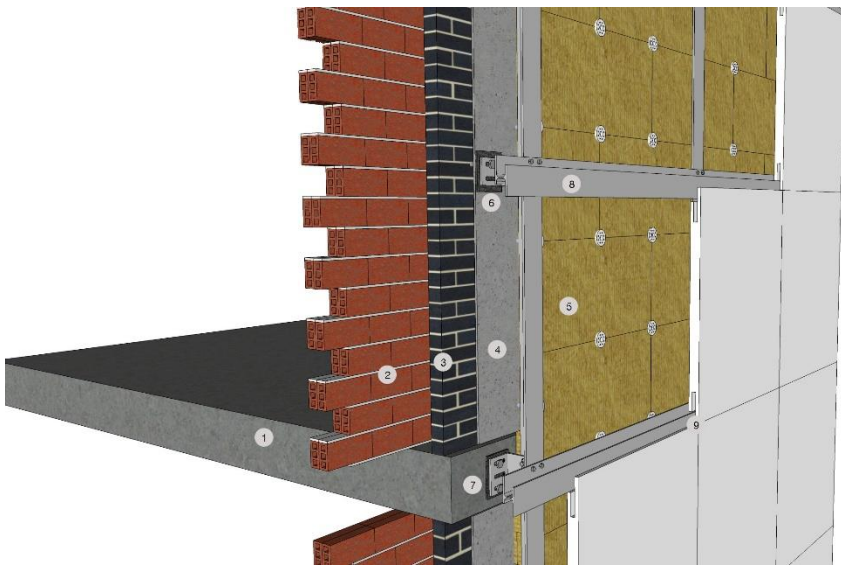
Imagen volumétrica de fachada ventilada con subestructura
